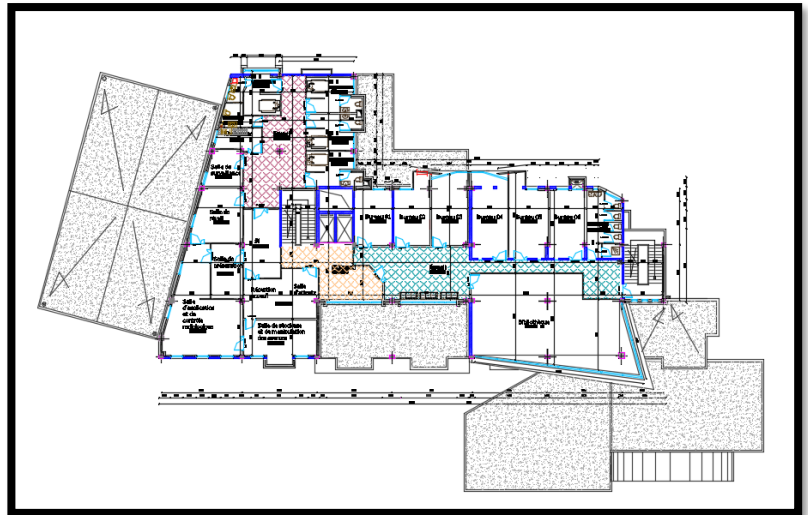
Plan R+4 ; Source : BET NABIL GAHAM
